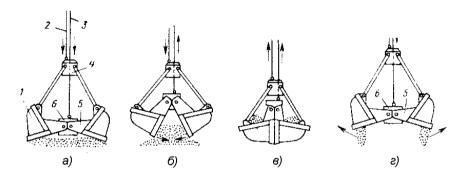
Схема работы двухканатного грейферного ковша: а – исходное положение перед заполнением; б – заполнение; в – подъем; г – разгрузка; 1 – челюсть; 2 – подъемный канат; 3 – замыкающий канат; 4 – верхняя головка; 5 – тяга; 6 – нижняя головка
